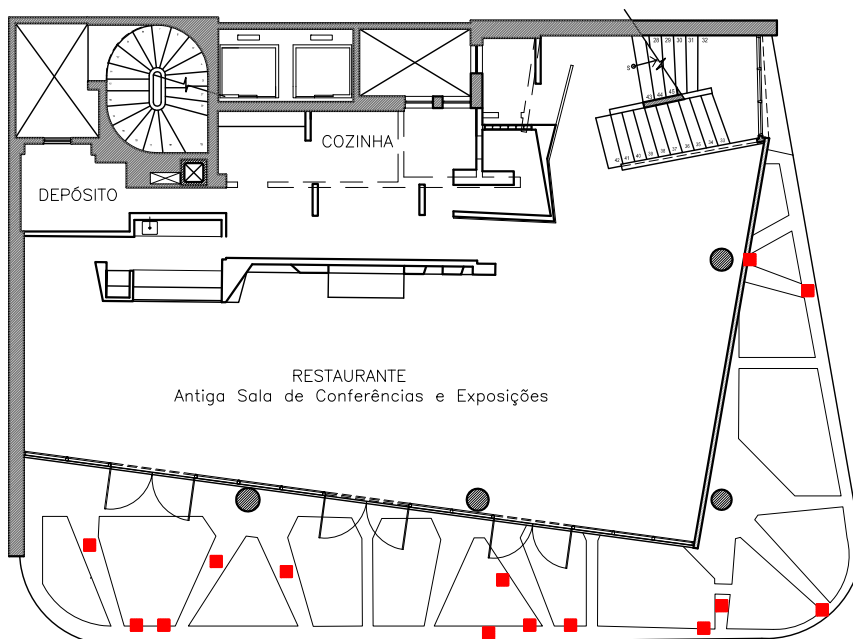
Planta do Terceiro Pavimento - Identificação das armaduras expostas - Escala 1:200
